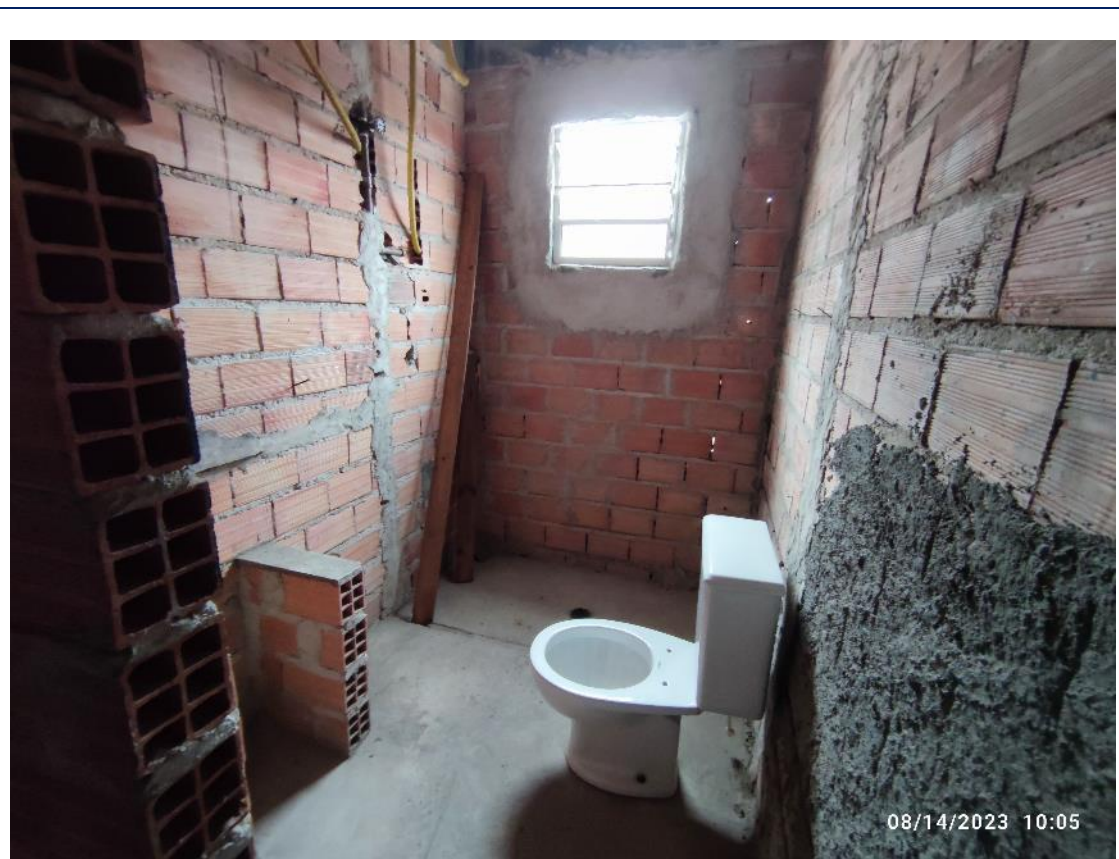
Mais uma vista da obra do terceiro pavimento.
